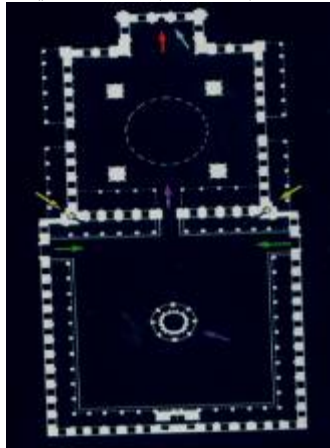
مسقط أفقي لجامع أحمد ابن طولون
